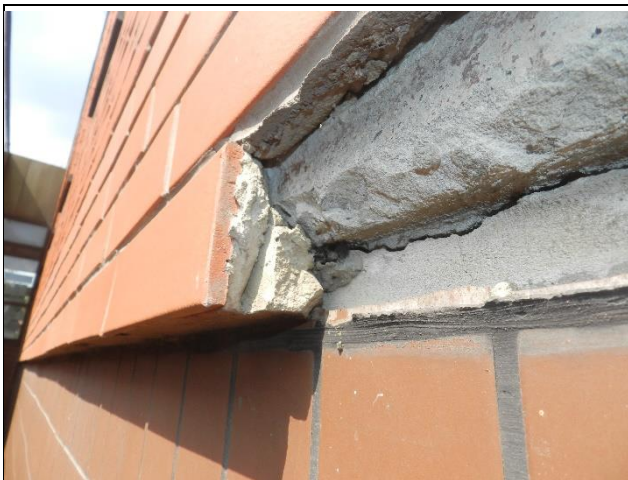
Zarysowanie elewacji oraz uszkodzenie płytek na elewacji południowej budynku nr 2
